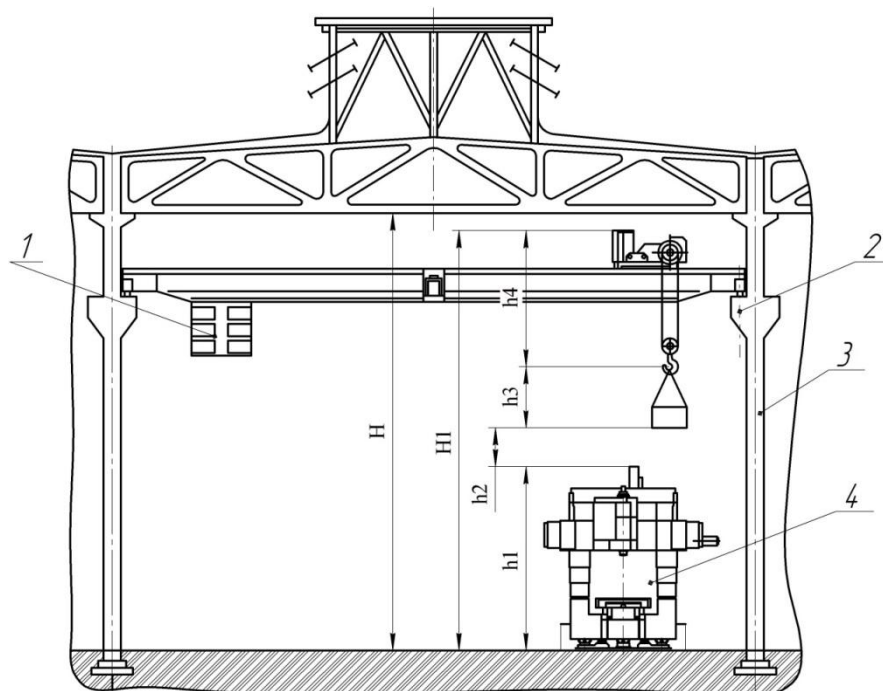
Поперечный разрез пролета: 1 – кабина крана; 2 – ось подкрановых путей; 3 – продольная разбивочная ось (колонна); 4 – технологическое оборудование
